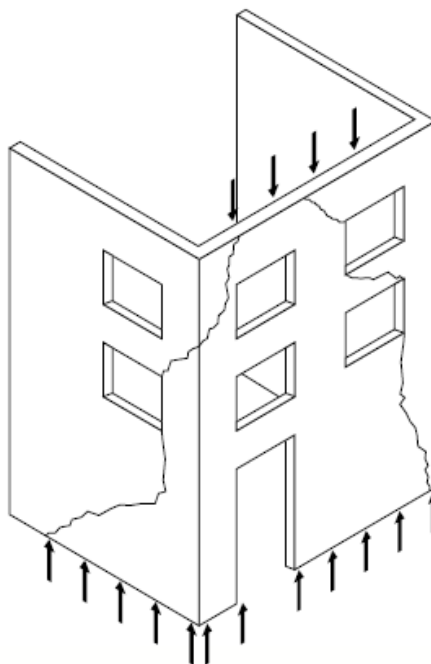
Tipologia da fissuração originada pela sobrecarga localizada
